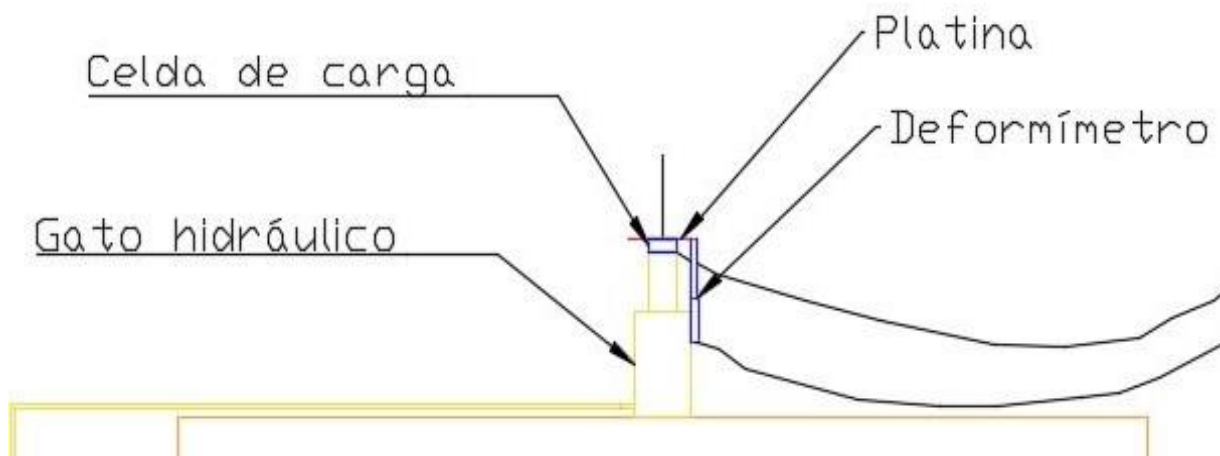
Detalle para la instalación de deformímetro y celda de carga a tracción. Elaboración propia
